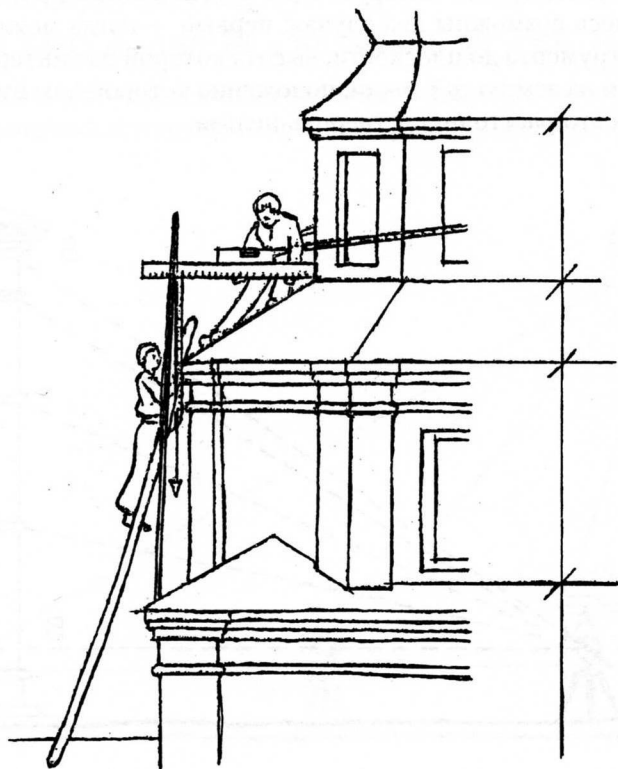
Обмеры внешних контуров фасада ярусного здания
